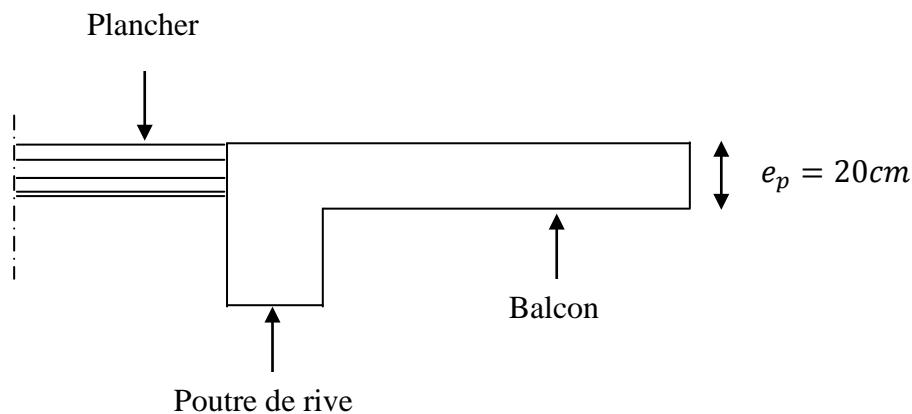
Coupe verticale détaillant la liaison balcon – poutre.
